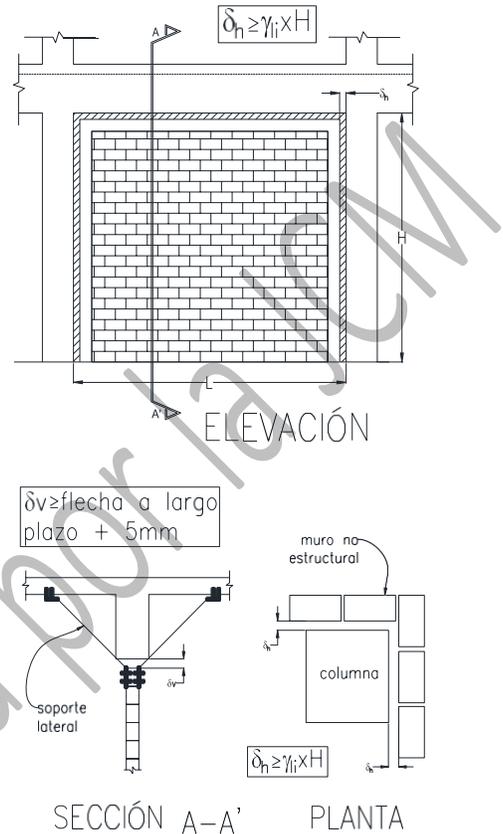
Holguras entre muros no estructurales y columnas y vigas
